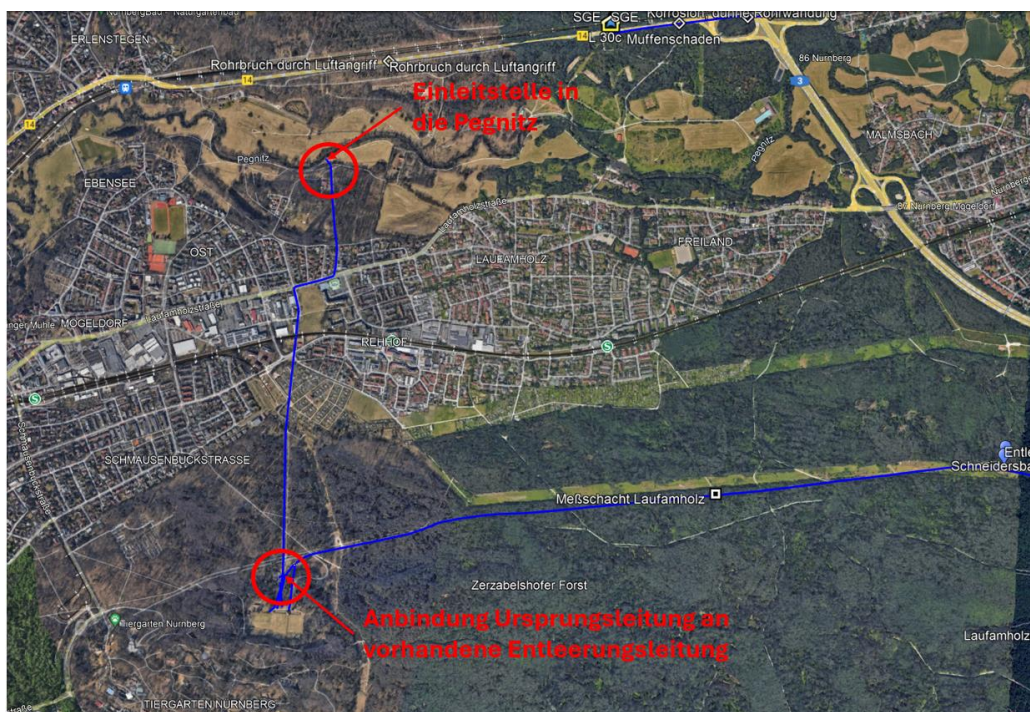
Ausschnitt aus dem Übersichtslageplan
